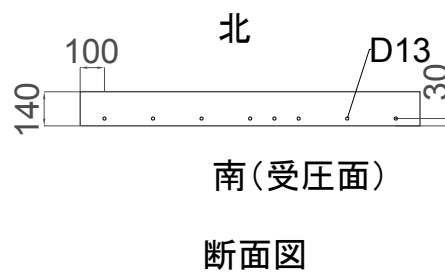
RC 塀の断面図立面図 (単位 : mm)
